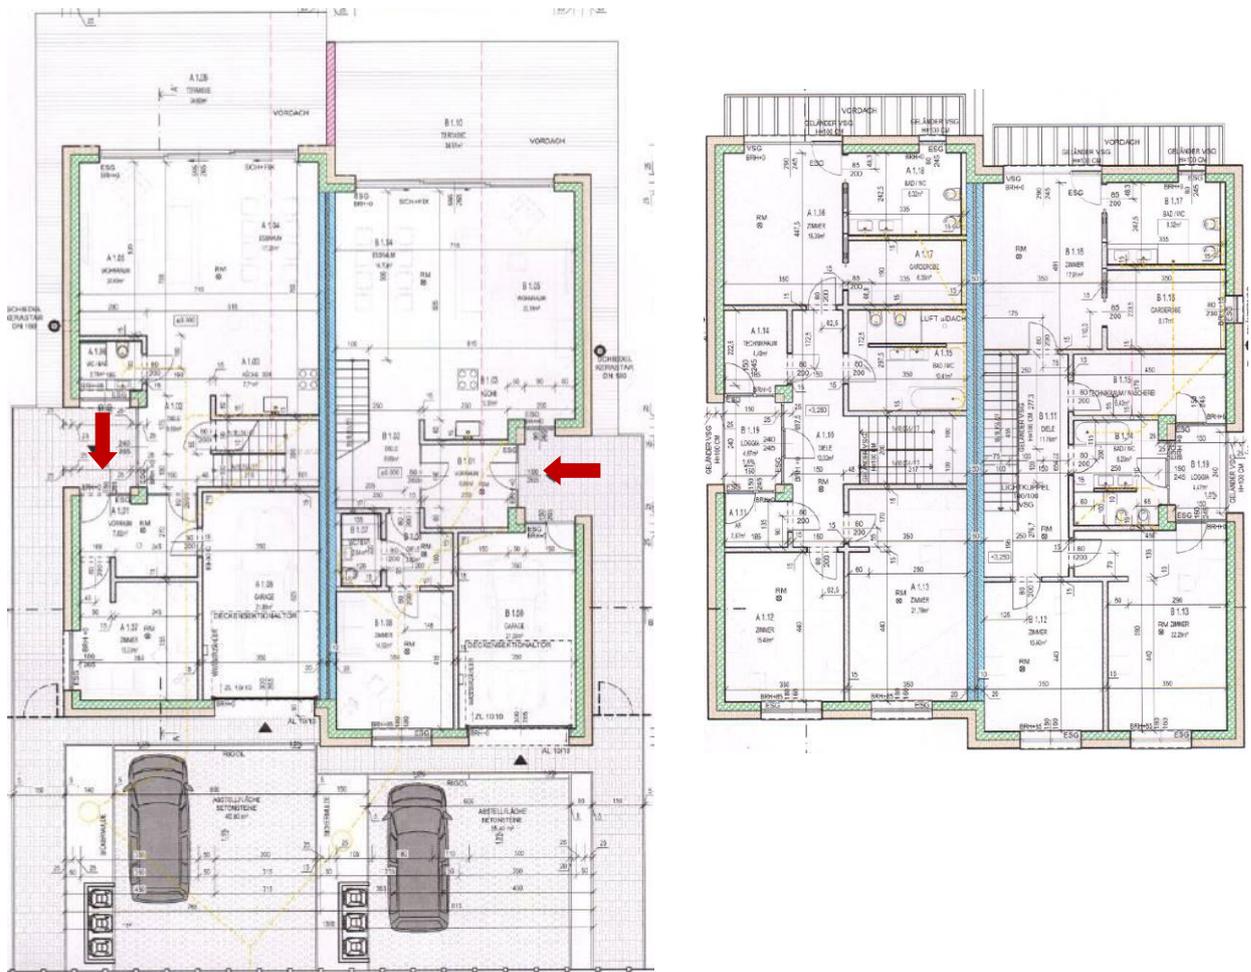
Grundrisse EG und OG mit Ergänzung SV (Pfeile); Quelle: Einreichplan Bauakt
